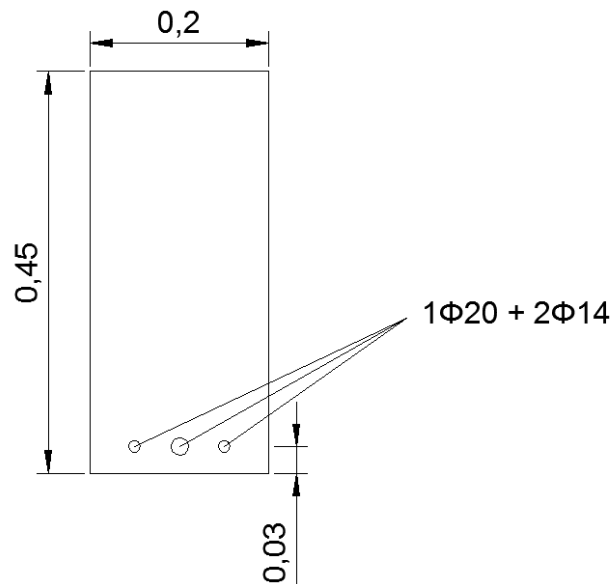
Detalle del armado de la barra. Cotas en m.
